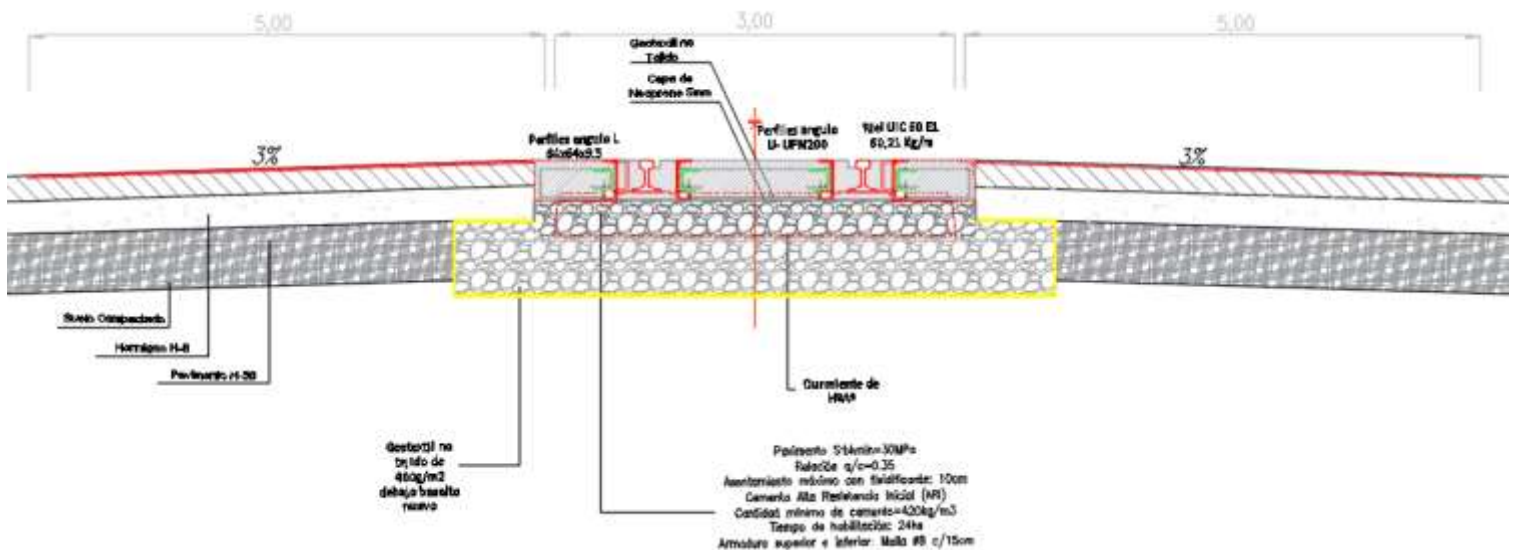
Perfil de un Paso a Nivel pavimentado. Fuente: ADIFSE
